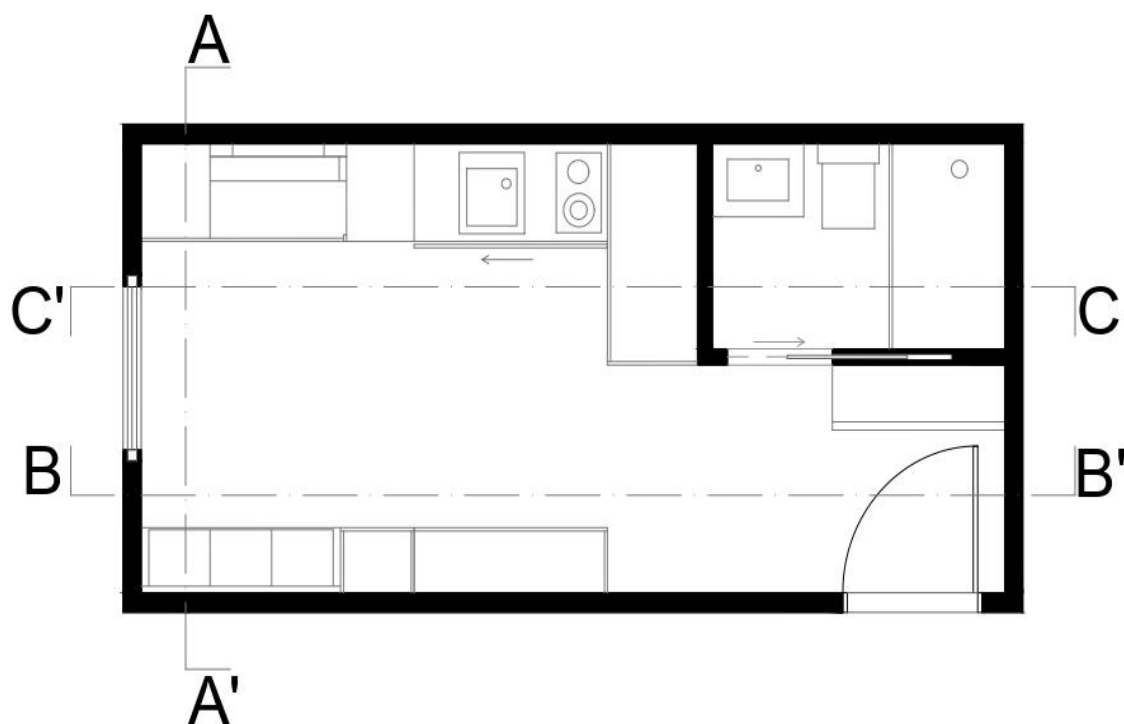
Planta do módulo 1 (Ferreira, 2020)
